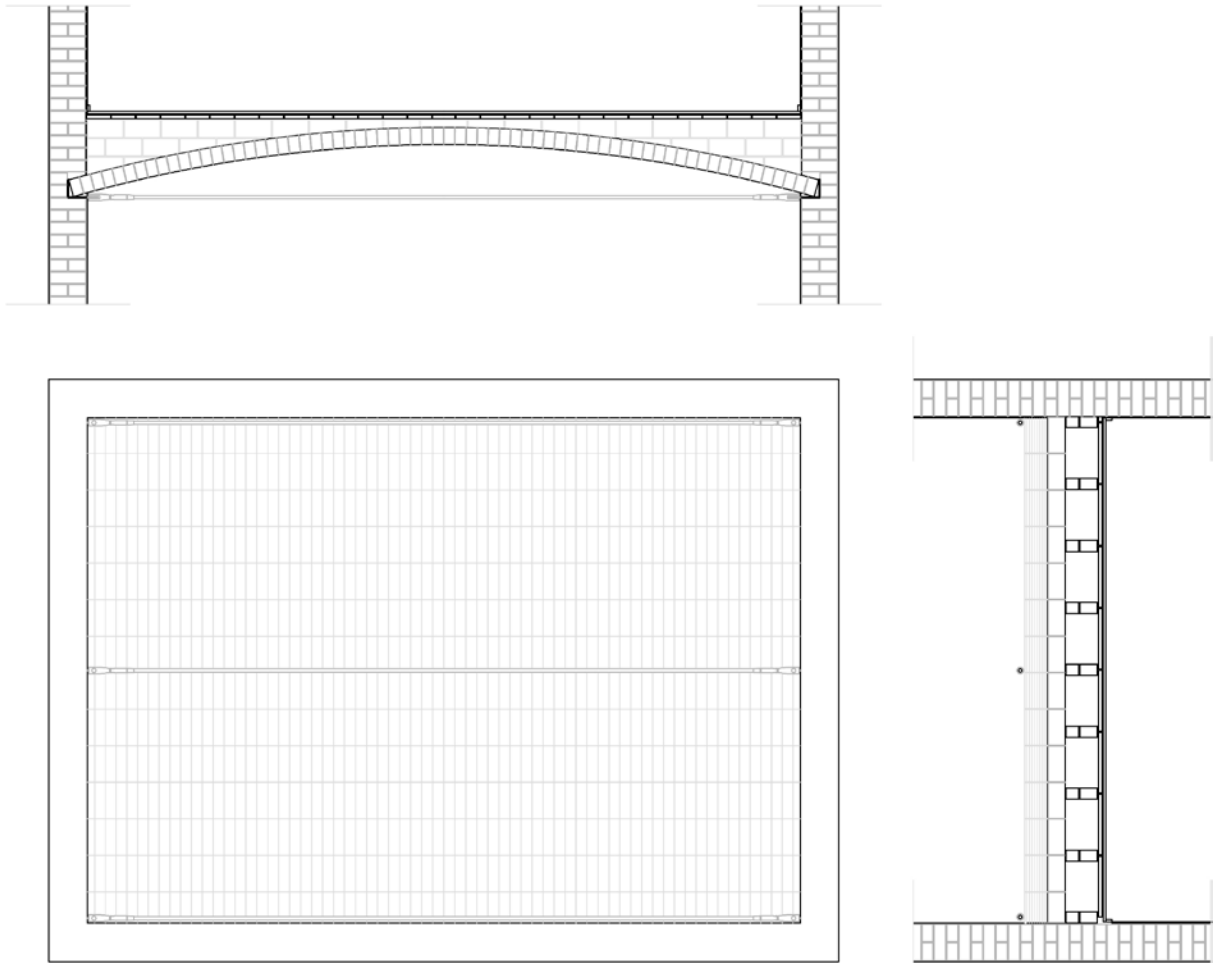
Detalle constructivo tipo de la solución calculada. Bóveda de BTC, formación de la superficie pisable, sistema de atirantado y encuentro con el muro
